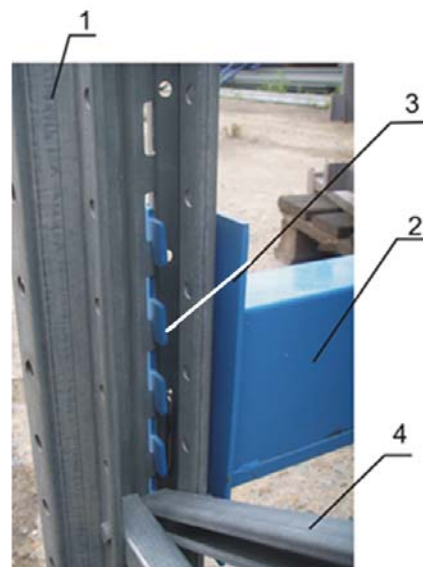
Конструкция стеллажа: 1 – стойка; 2 – балка; 3 – зацепы стыкового фланца балки; 4 – распорка
